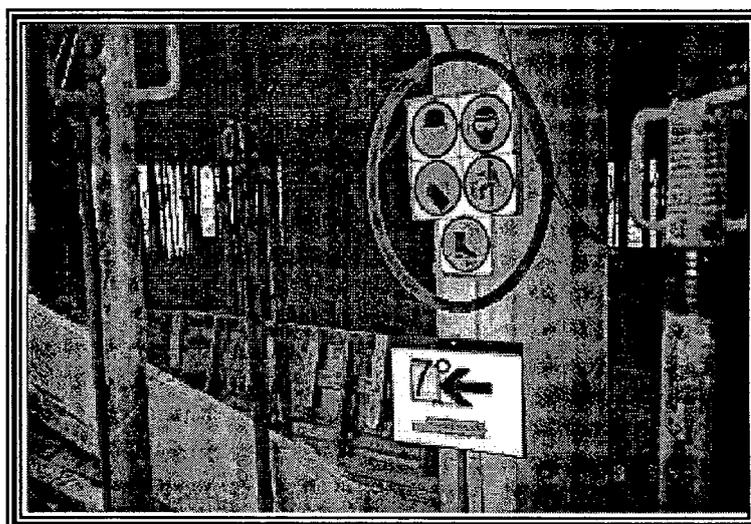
Foto sinalização EPI para pavimento executando desfôrma de laje
